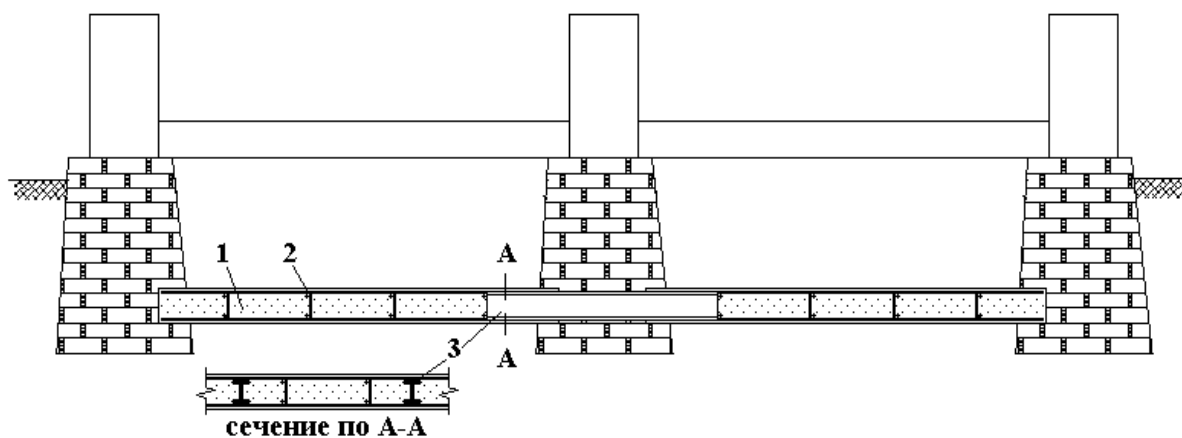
Підведення фундаментної плити: 1 – бетон; 2 – арматура; 3 - балка
